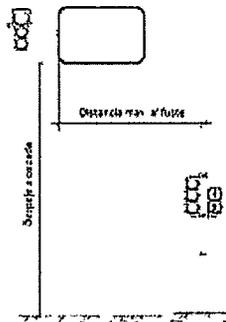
Ubicación de cartelería vial en Columnas con pescante
